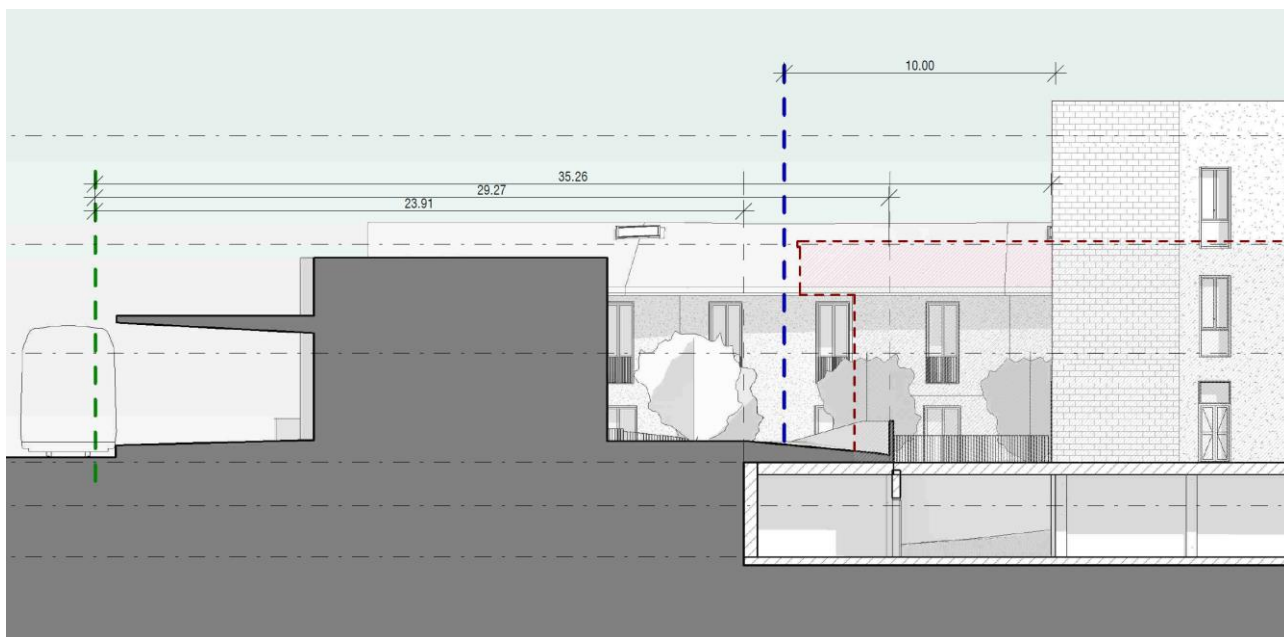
sezione longitudinale per la determinazione delle distanze dal sedime ferroviario -dettaglio
